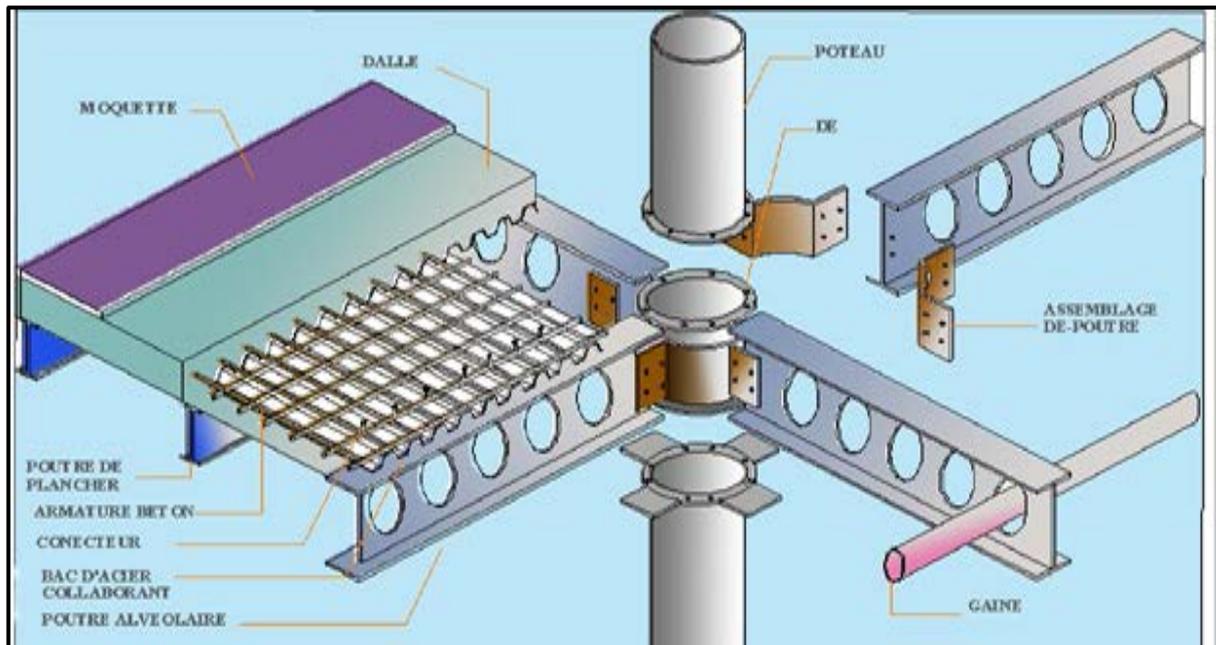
Détail de jonction (Poteau, Poutre, plancher).
